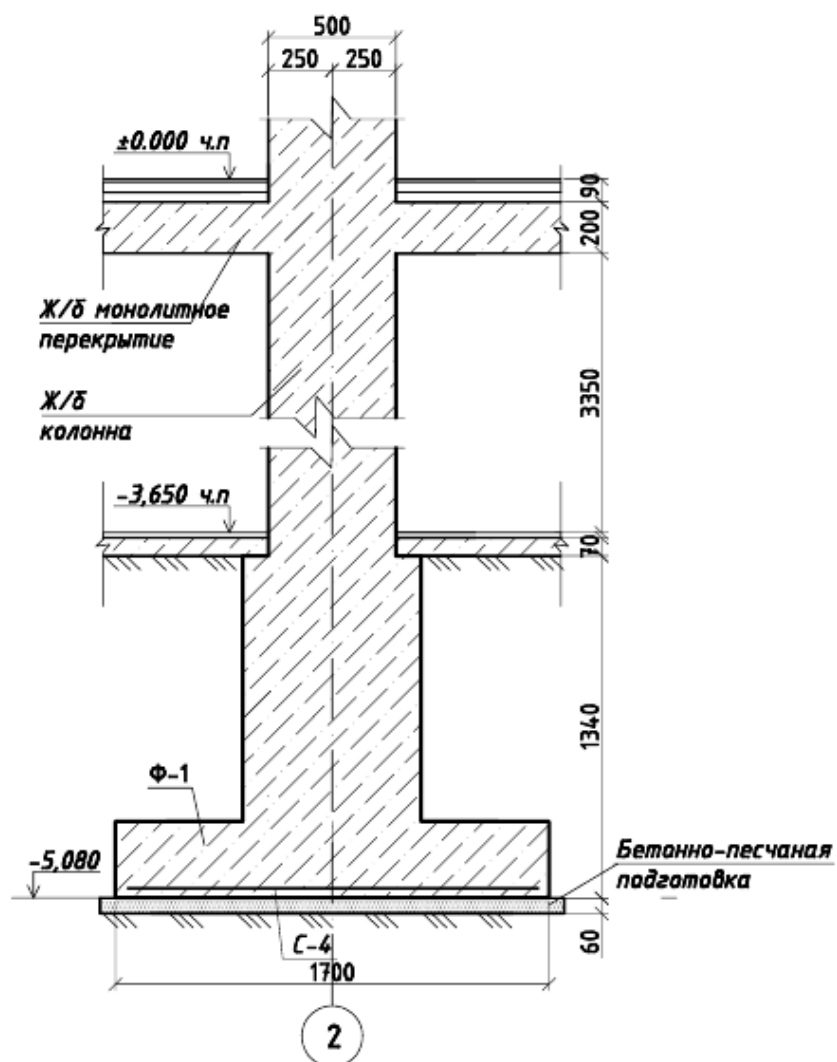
Конструктивная схема ленточного монолитного фундамента с цокольным этажом в сечении 1-1
